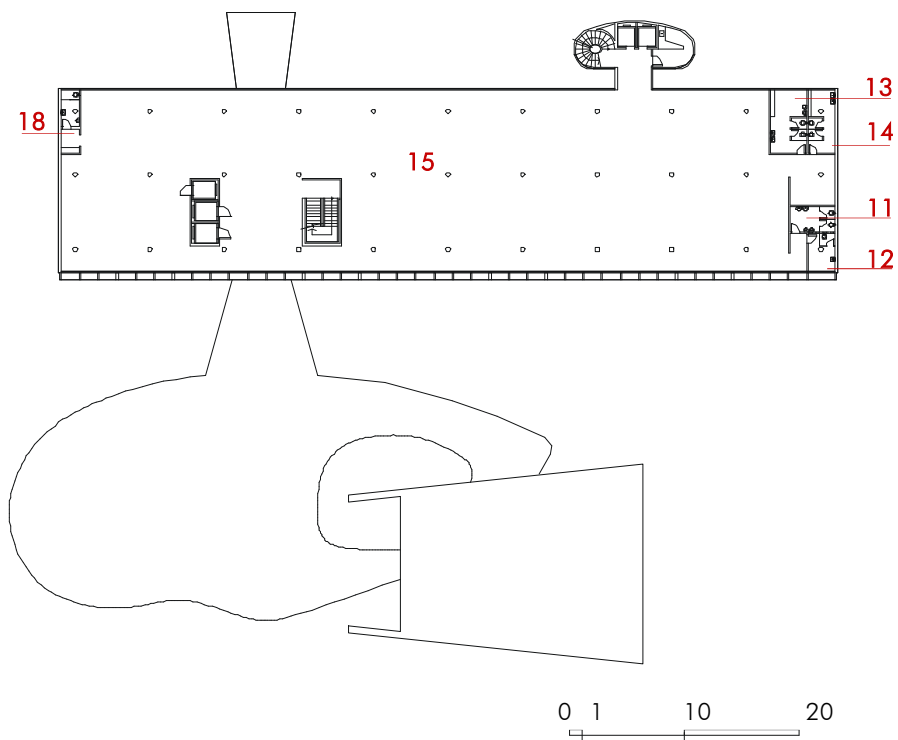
Planta do primeiro e segundo pavimento (andar tipo): Paço e Câmara Municipal de Bauru.
